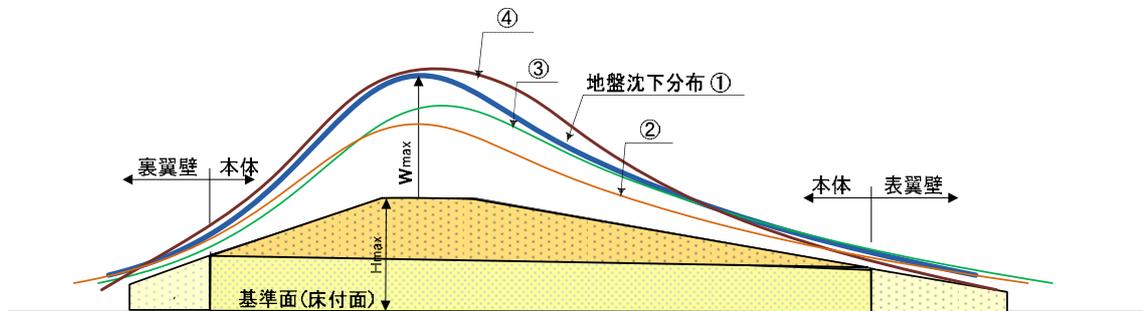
地盤沈下分布とキャンバー盛土の計画図
